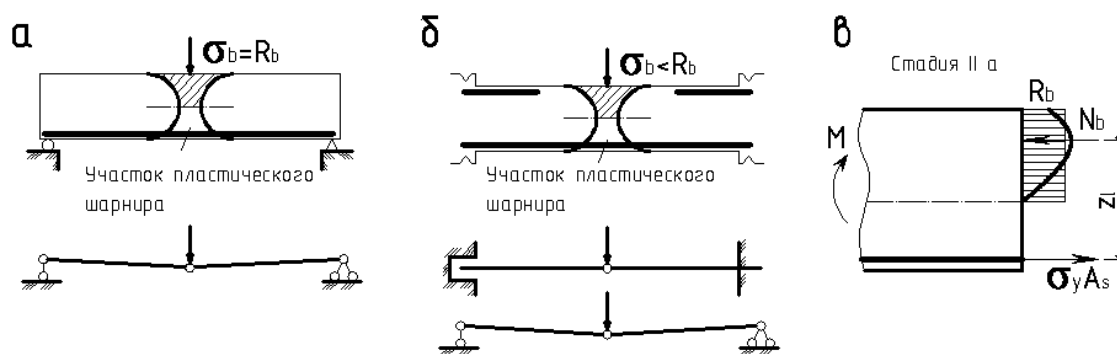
Схема образования пластического шарнира в железобетонных балках
